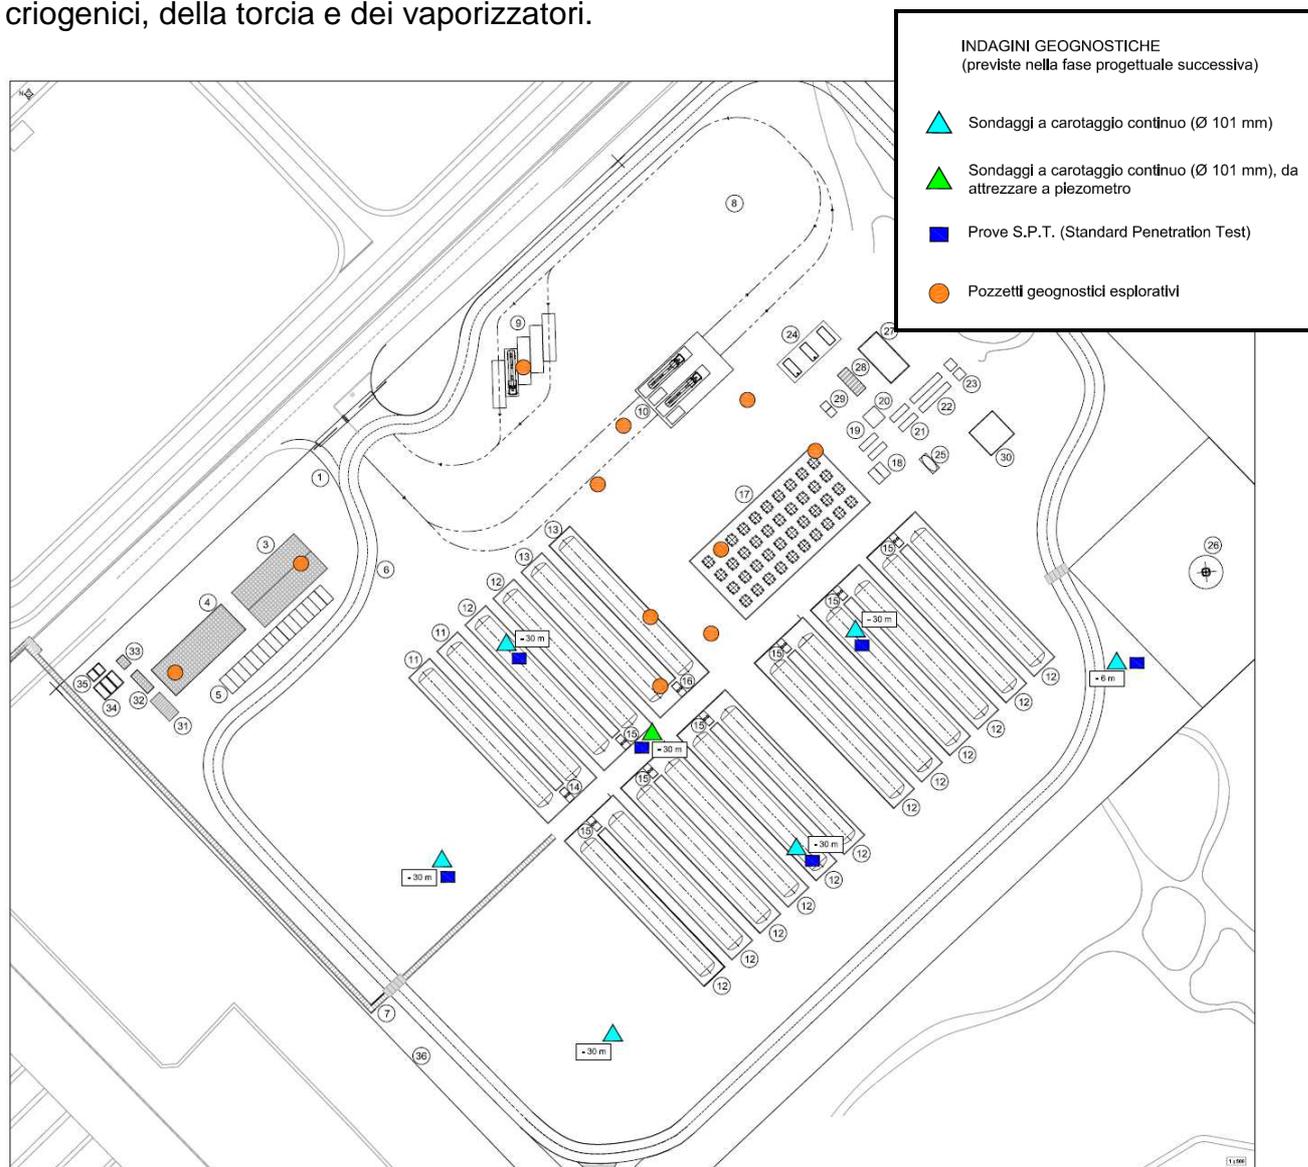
Stralcio della planimetria indagini geognostiche previste.
